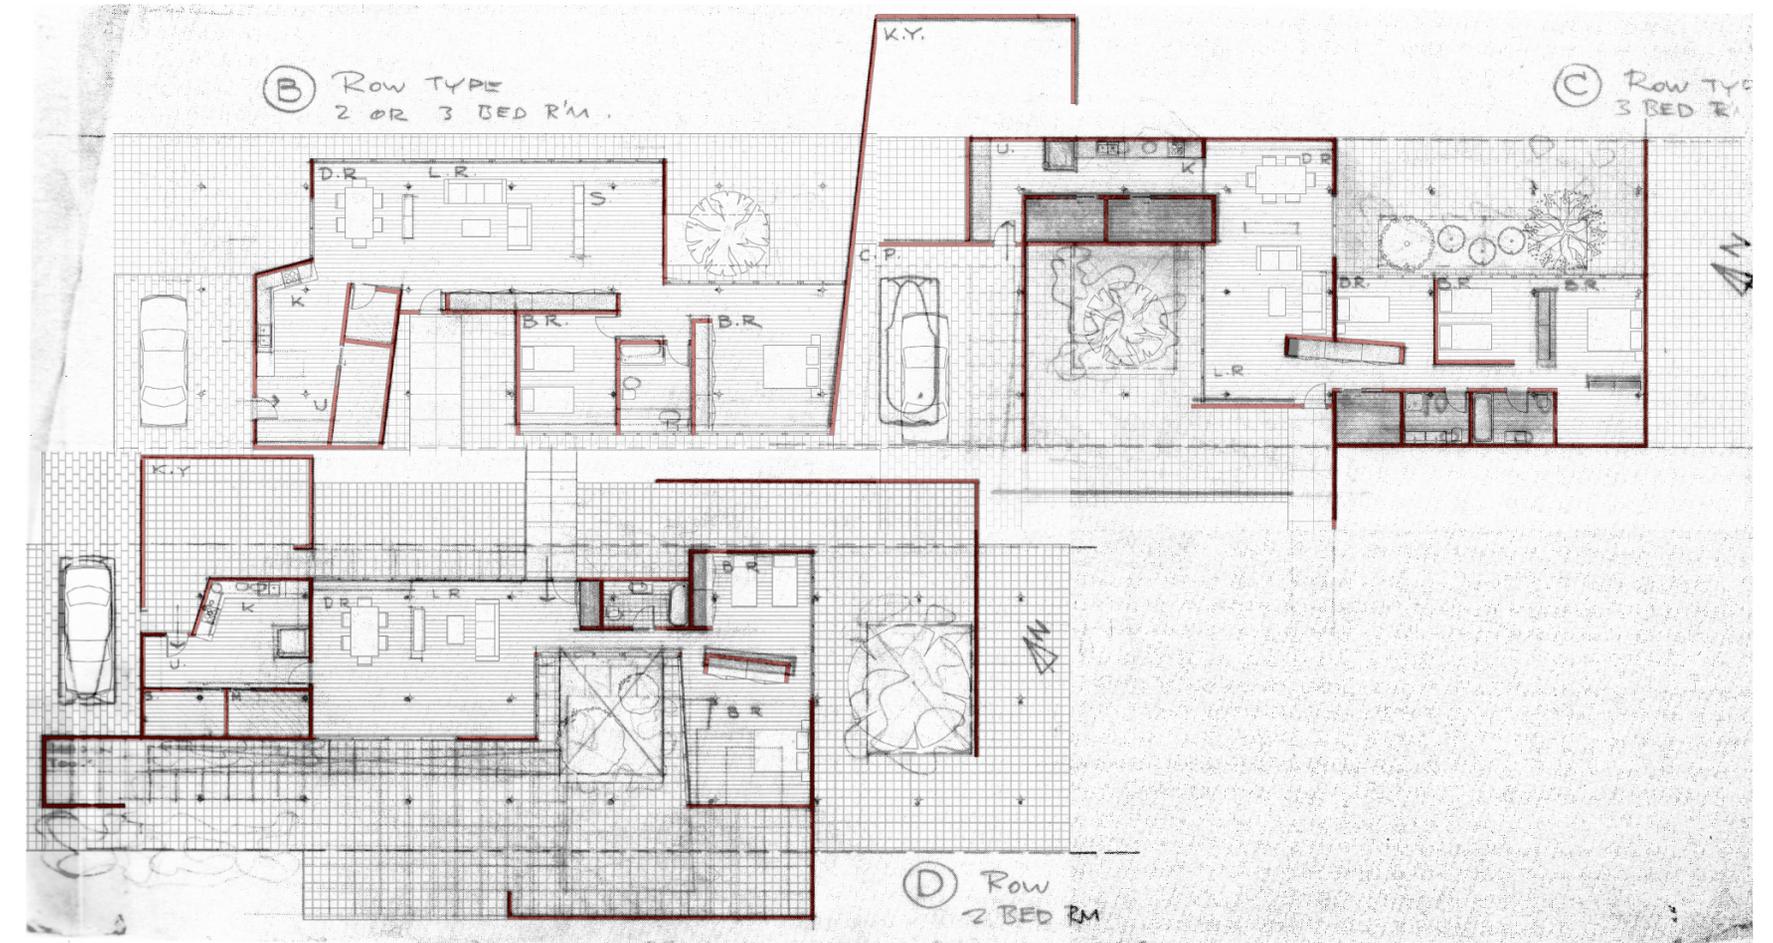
Superposición de las plantas viviendas tipo B, C y D redibujadas sobre el croquis original de Kahn.
